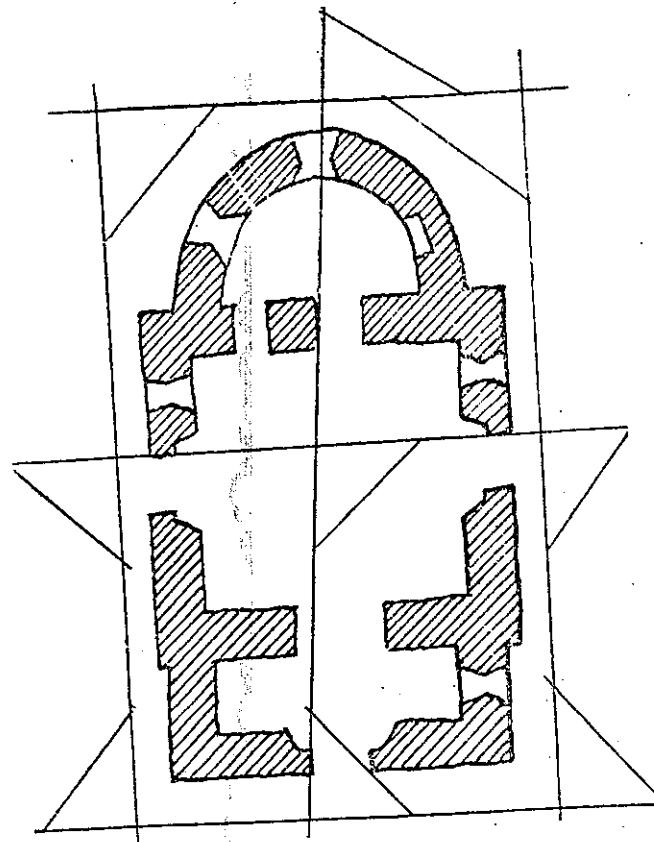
План здания со связанными между собой наружными и внутренними причалками
